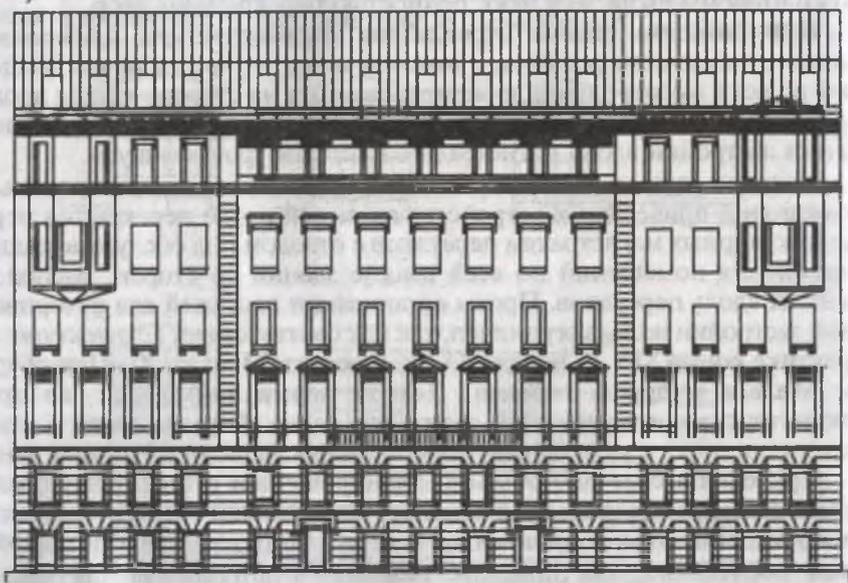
Фасады доходного дома в г. С.-Петербурге:
